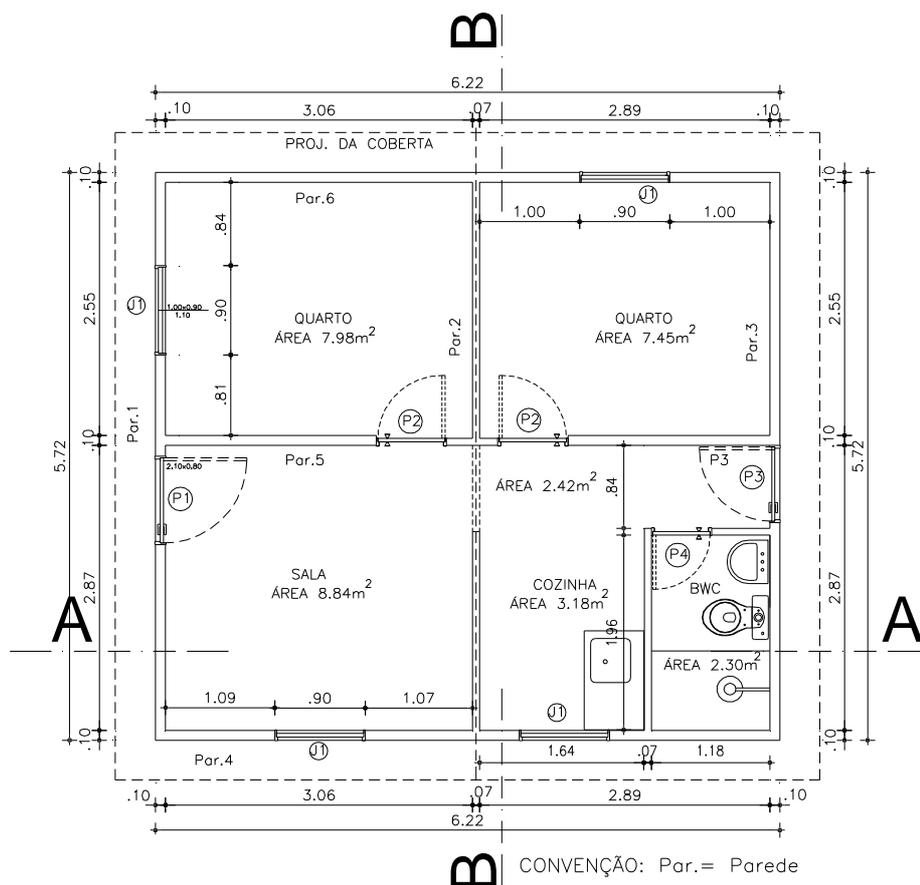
Planta baixa do protótipo construído pelo ITEP, RT nº 021.977 (ITEP, 2007)
